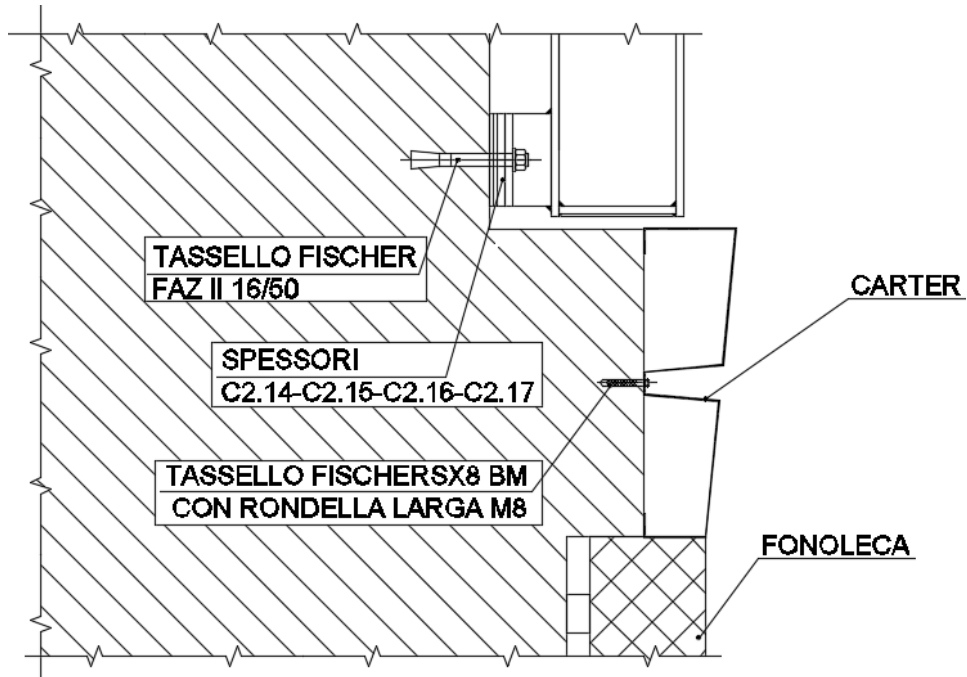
Dettaglio del collegamento inferiore HEA200 e HEA180 barriera lato ferrovia
